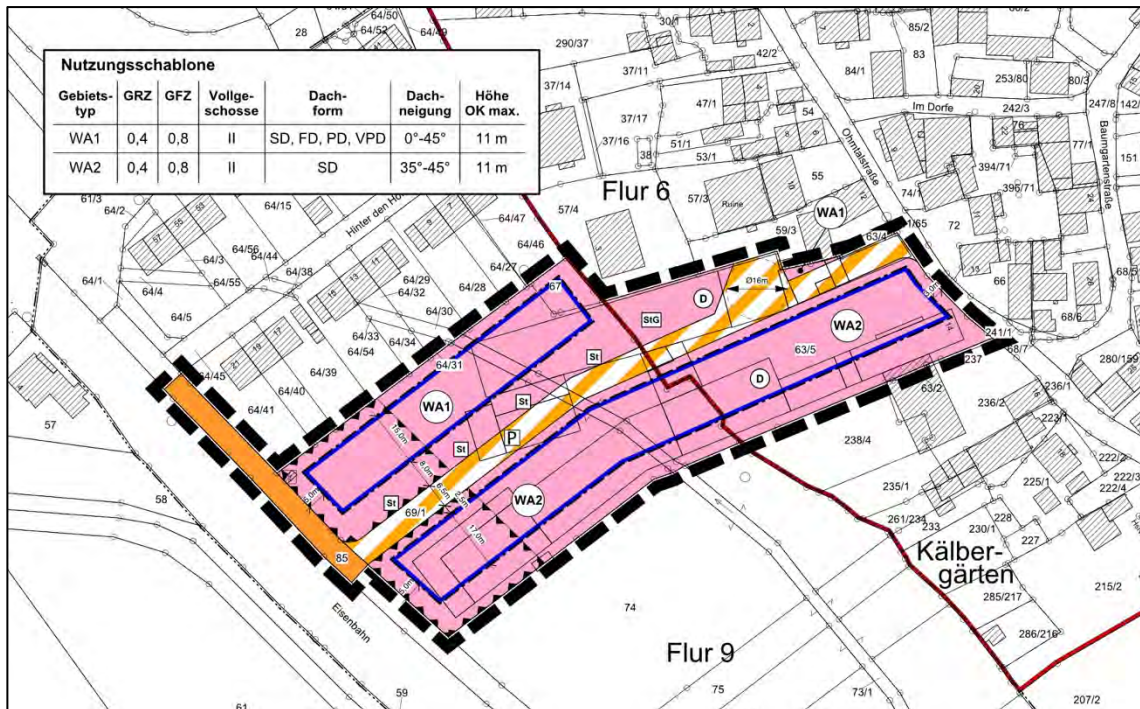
Bebauungsplan „Ohmtalstraße 14“ - Planteil
